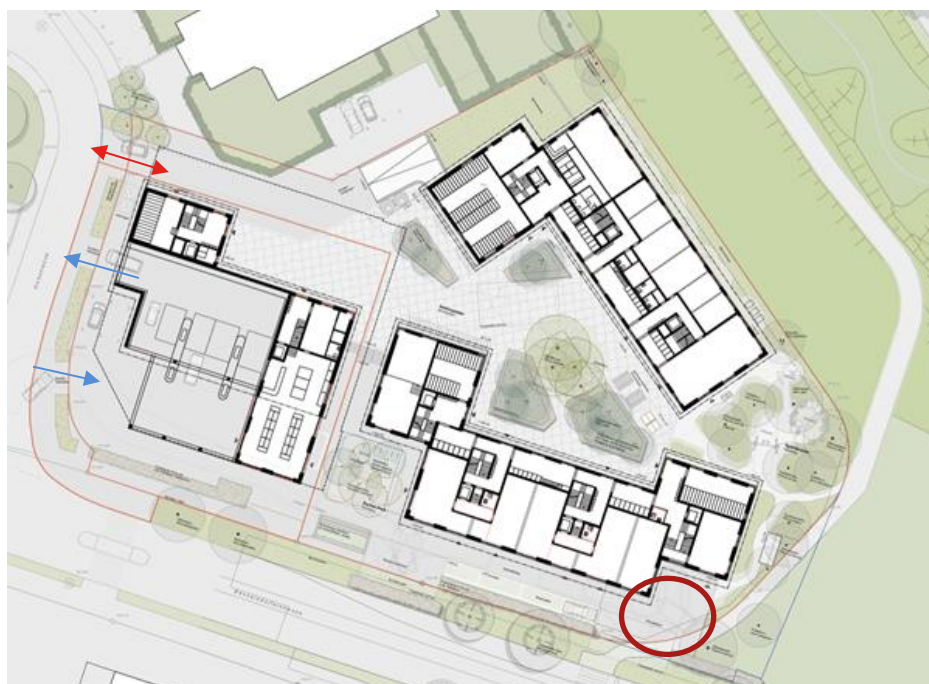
Planausschnitt Umgebungsgestaltung (blaue Pfeile=Ein- und Ausfahrt Tankstelle / Anlieferung / Kunden- und Besucher-Parkplätze / rote Pfeile= Ein- und Ausfahrt Einstellhalle Sektor C4, dunkelroter Kreis= Wendemöglichkeit)
